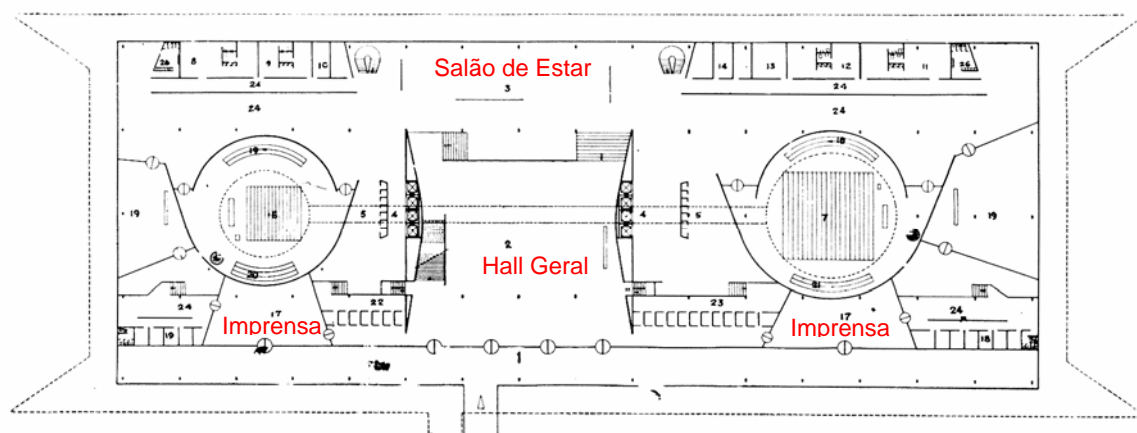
Anteprojeto 02 – Edifício Principal – Pavimento Térreo. 1957.
